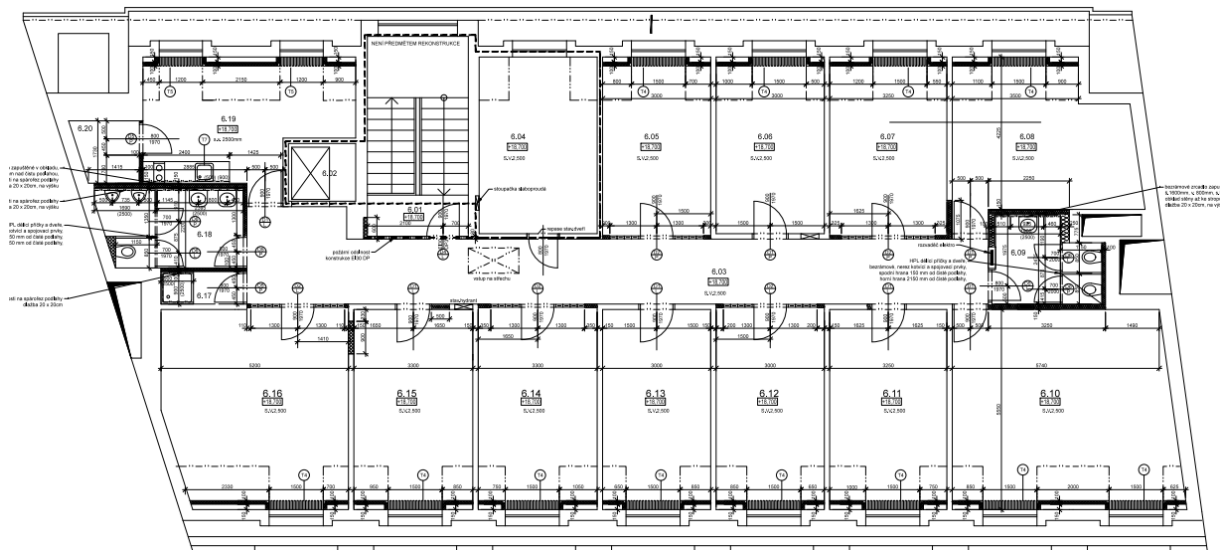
Půdorys 4.NP - Původní stav, Zdroj: (12)
